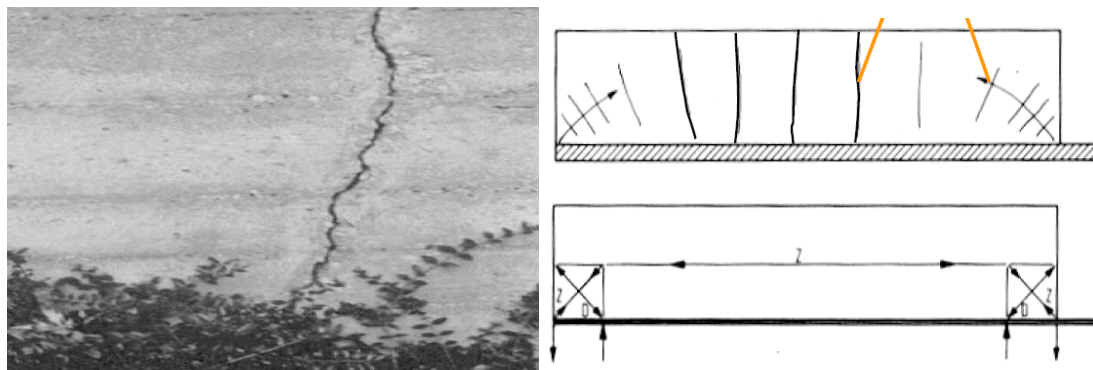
Tensões devido a retração nas paredes de um reservatório.
